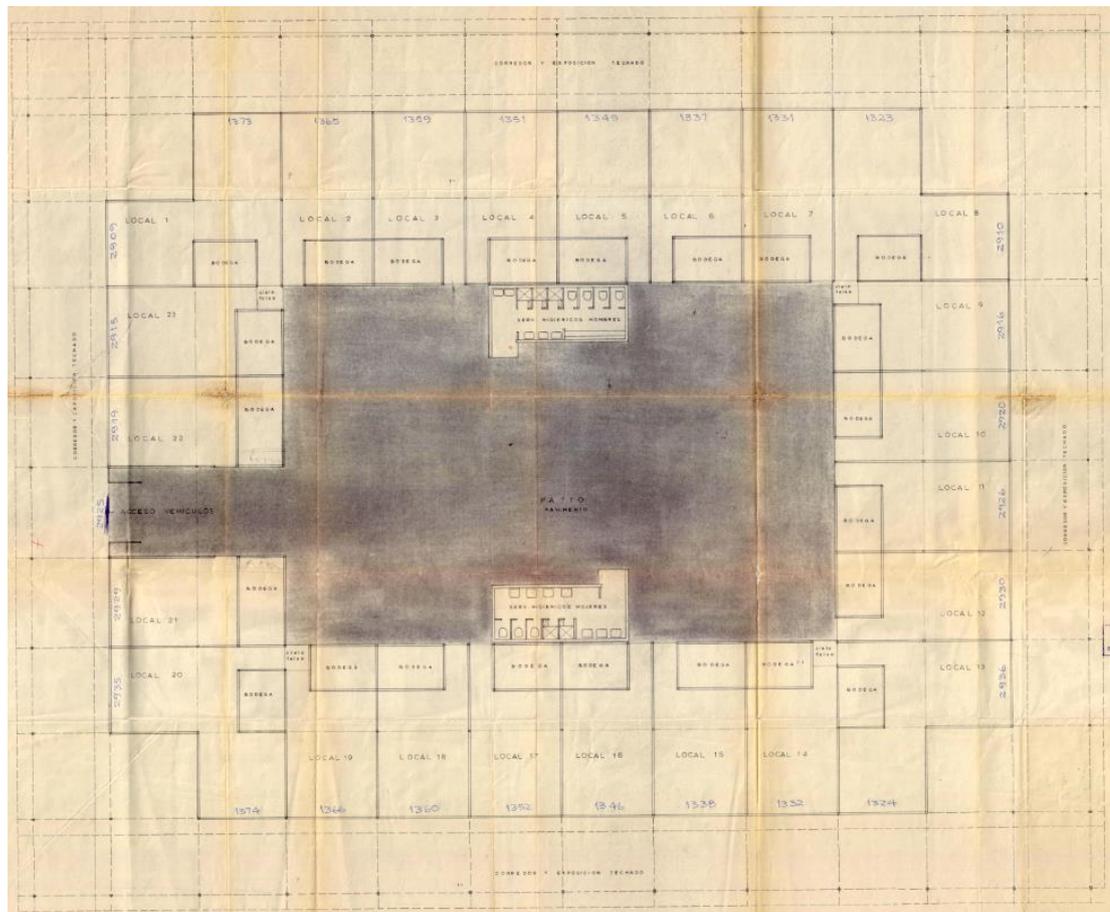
Planta de Ubicación, centro comercial barrio industrial menor
